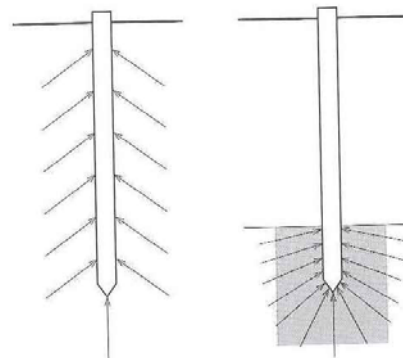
Mecanismos de sustentación; pilote fuste-columna y pilote columna
